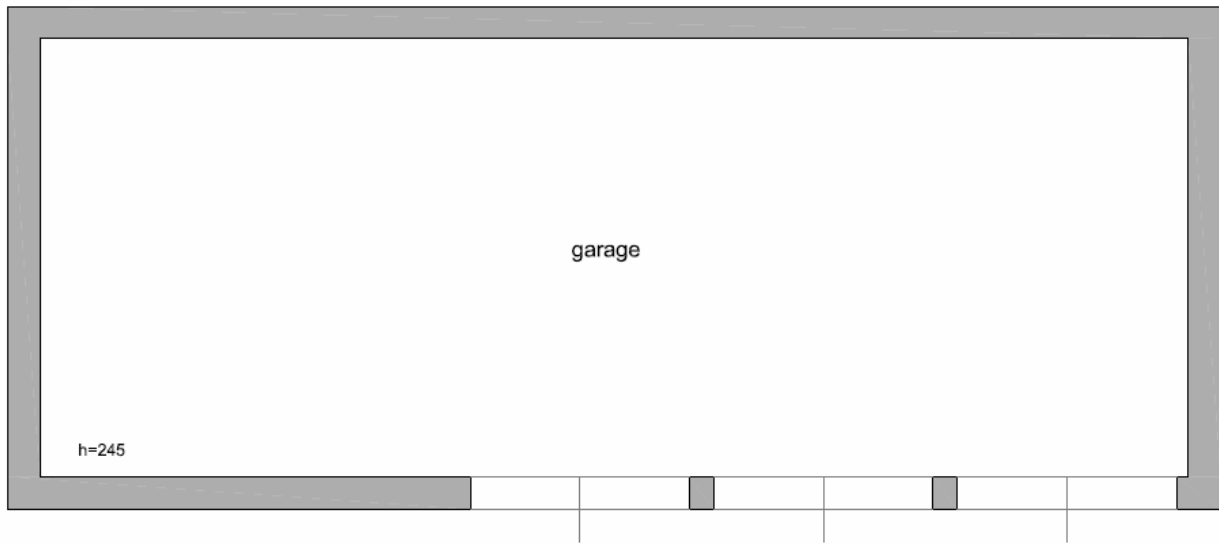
4.3.5 Planimetria garage – p.la 831.
